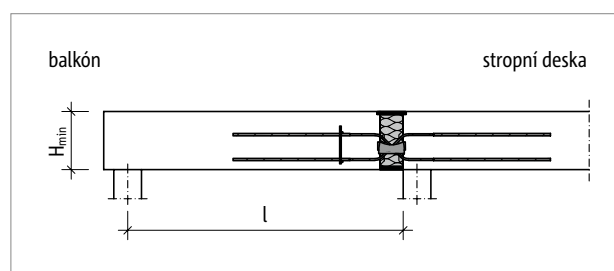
Schöck Isokorb® T typ QL-V2 až V6: Statický systém
